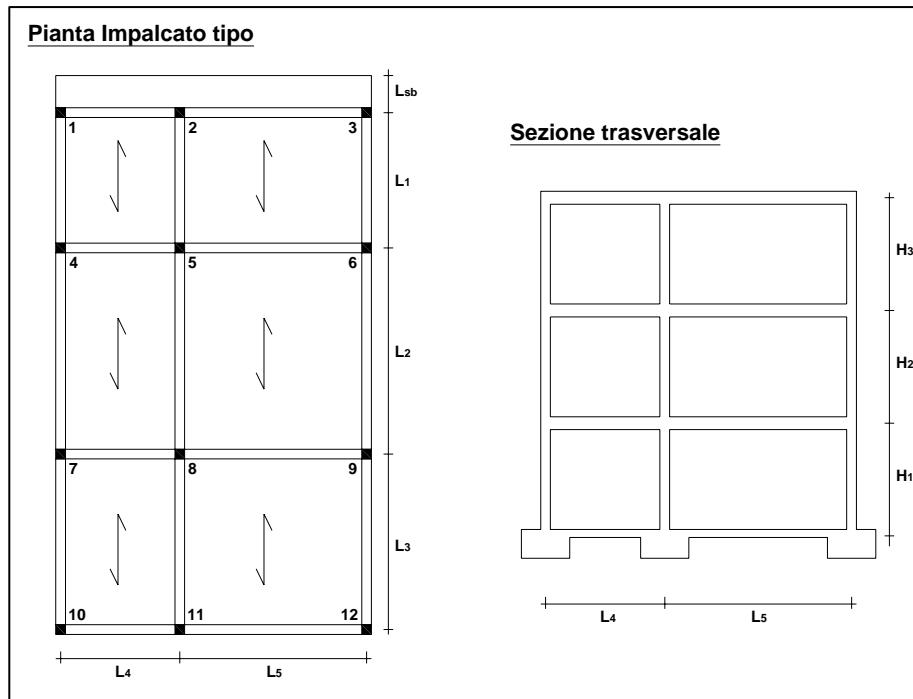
\_ Schema dell'impalcato tipo e della sezione verticale dell'edificio
